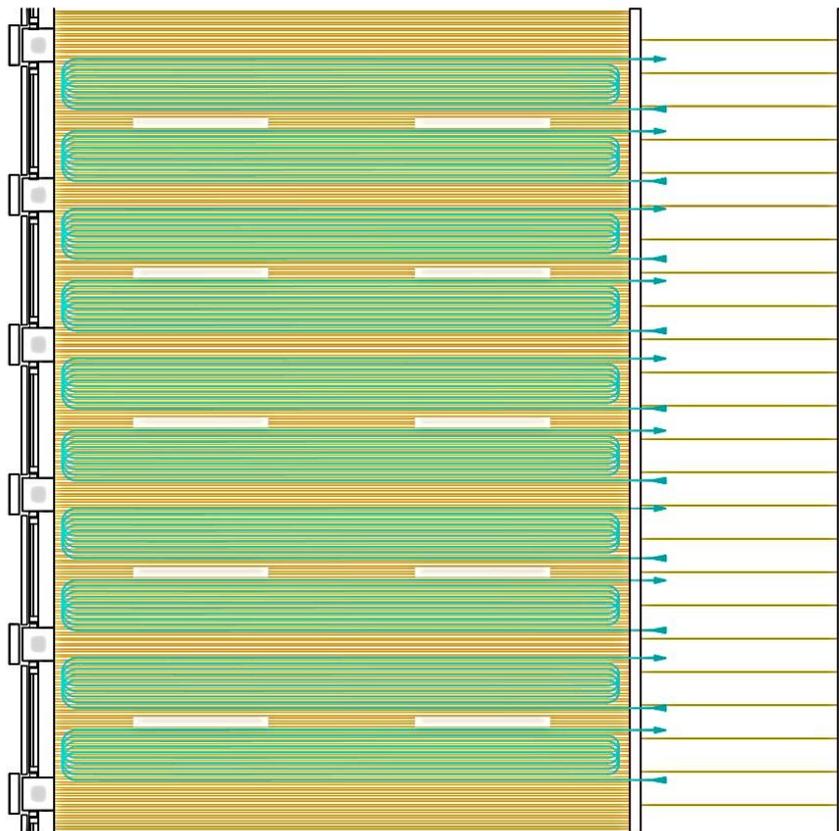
exemple de plan de principe plafond SAPP Ceiling®, modulation 1350 mm
